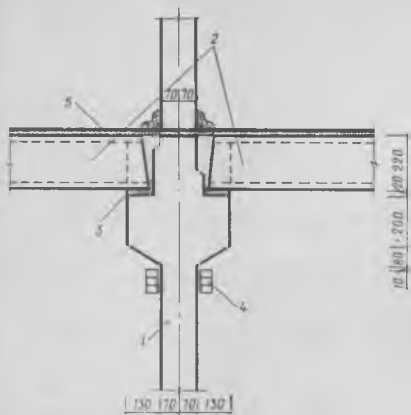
Узел опирания перекрытий на несущую внутреннюю стену
